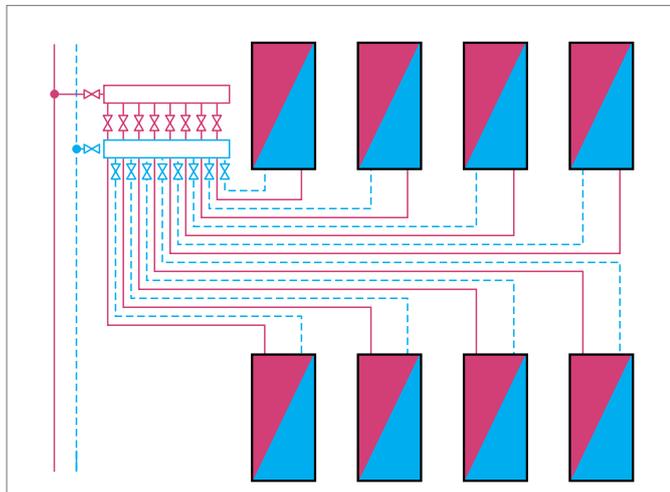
Rappresentazione schematica del collegamento a collettore
